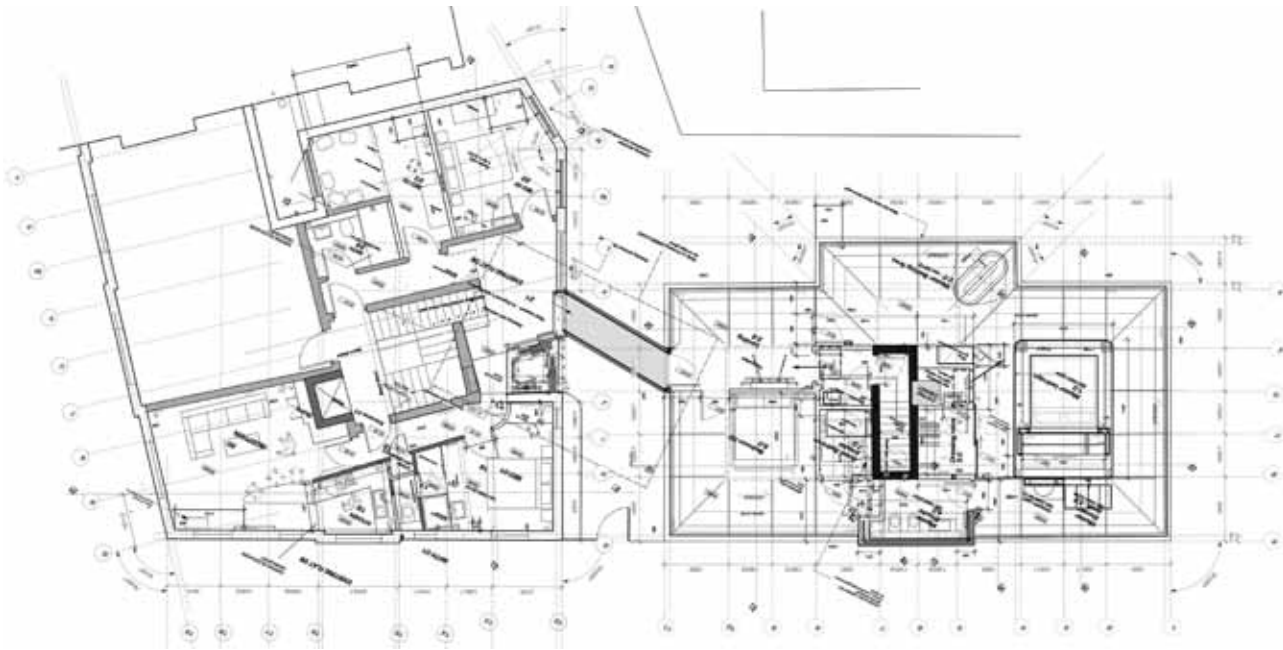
\_ 3.OG Grundriss © Studio RHE
